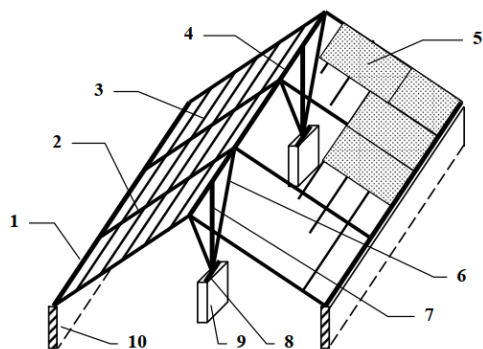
Схема розташування конструкцій приставного схильного даху: 1 – мауерлат; 2 – кроквяна балка; 3 – лати (обрешітка); 4 – гребеневий прогін; 5 – елементи покрівлі; 6 – поздовжній підкіс; 7 – стояк; 8 – підкладка; 9 – опора; 10 – стіна
